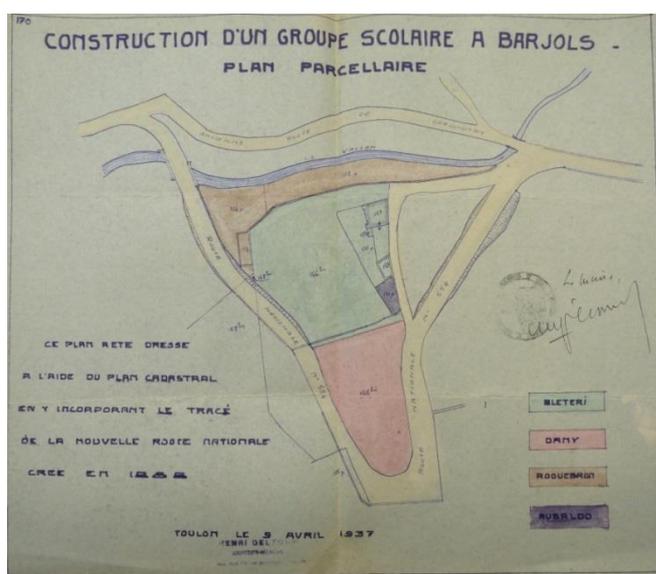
Construction d'un groupe scolaire à Barjols, plan parcellaire, Henri Deltour (architecte).
